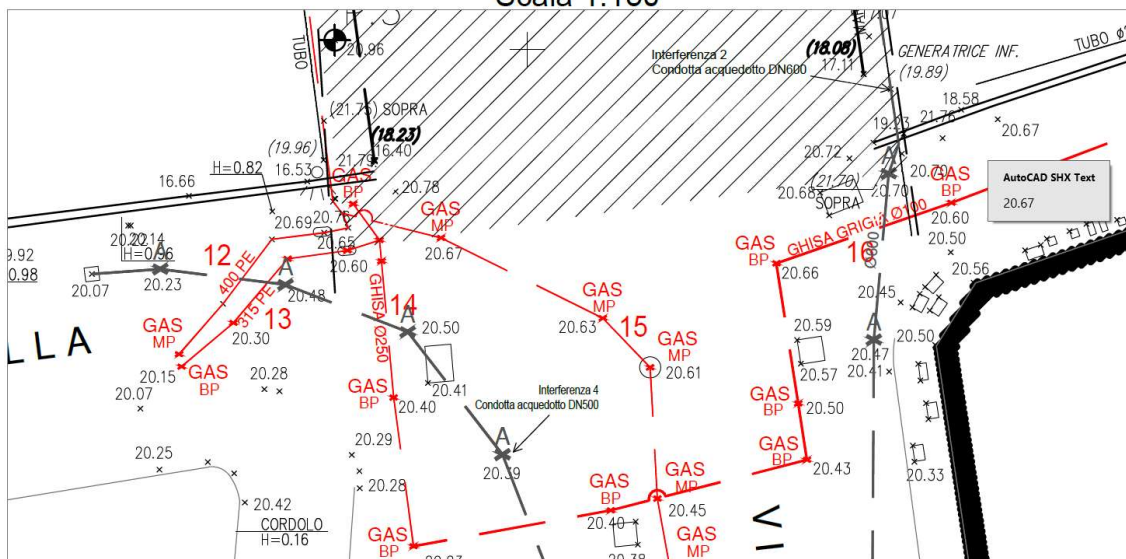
Planimetria di dettaglio dell'area a valle della spalla sud del ponte di via Canepari, con l'evidenza delle condotte del gas presenti. Il retino con linee nere in diagonale indica l'ingombro dell'intervento di sostituzione del ponte
